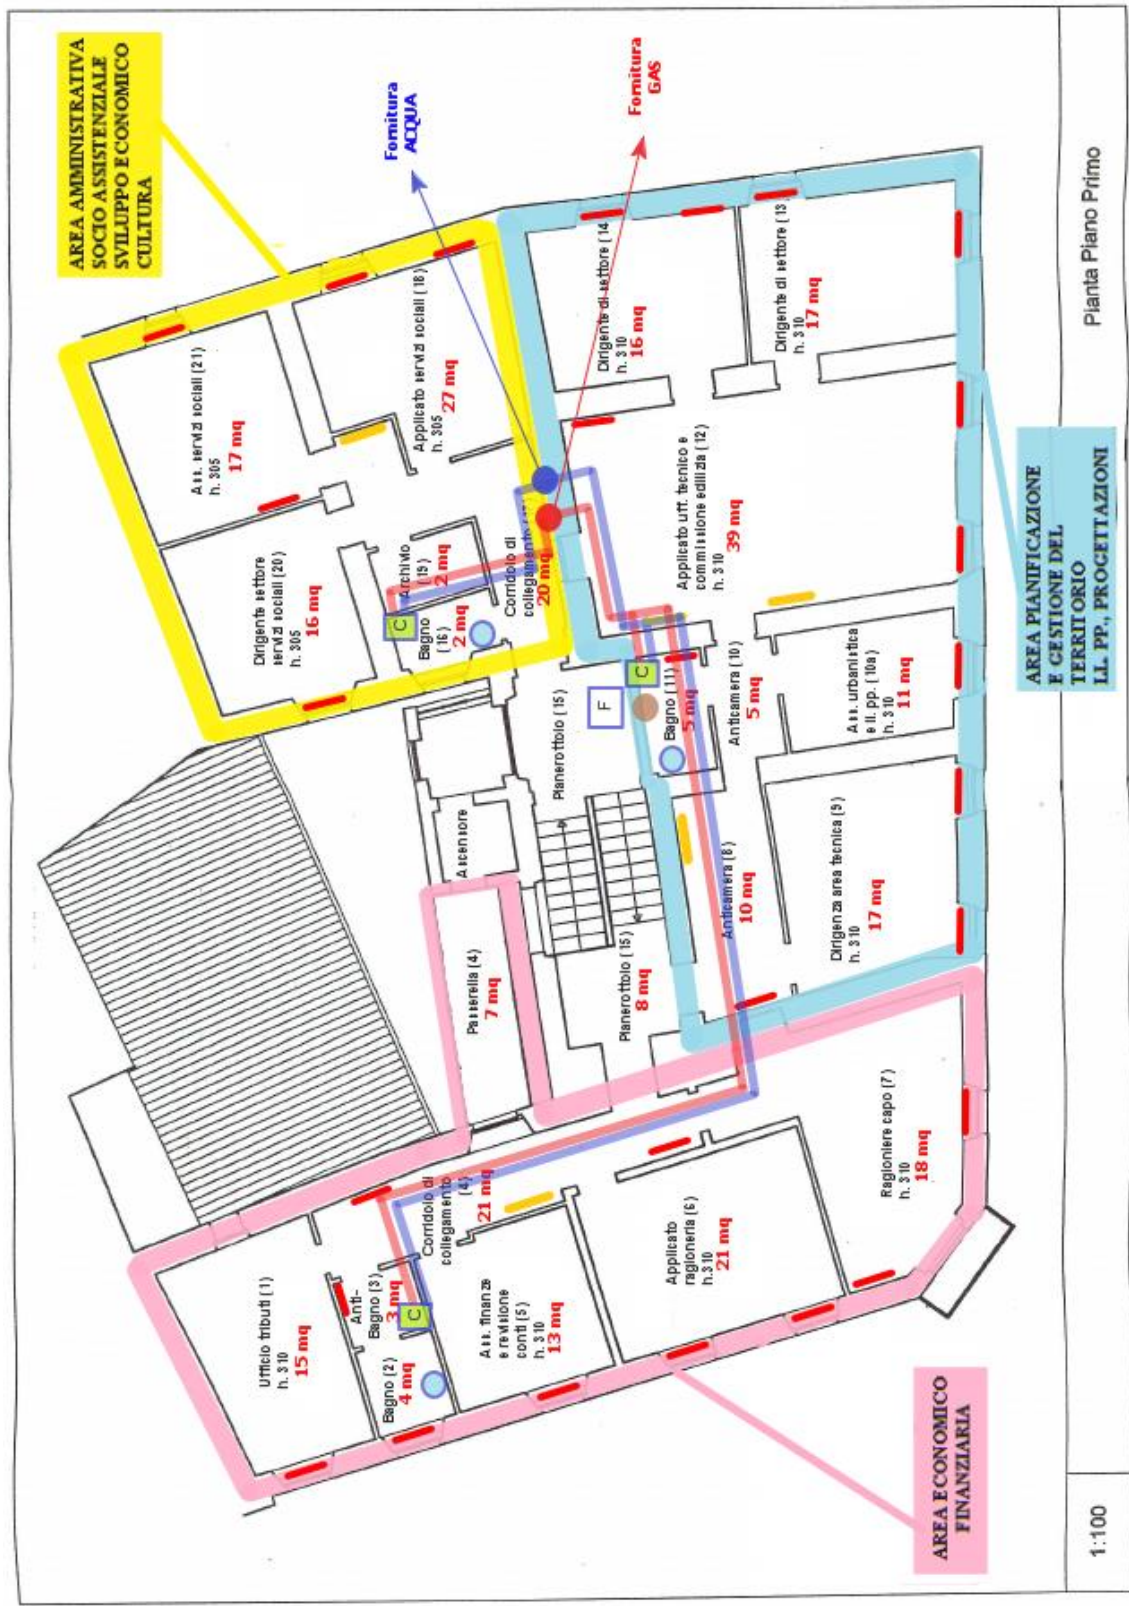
Planimetria del Piano Primo completa di suddivisione in aree funzionali e impianti presenti nell'edificio Comunale. (scala non rispettata)
